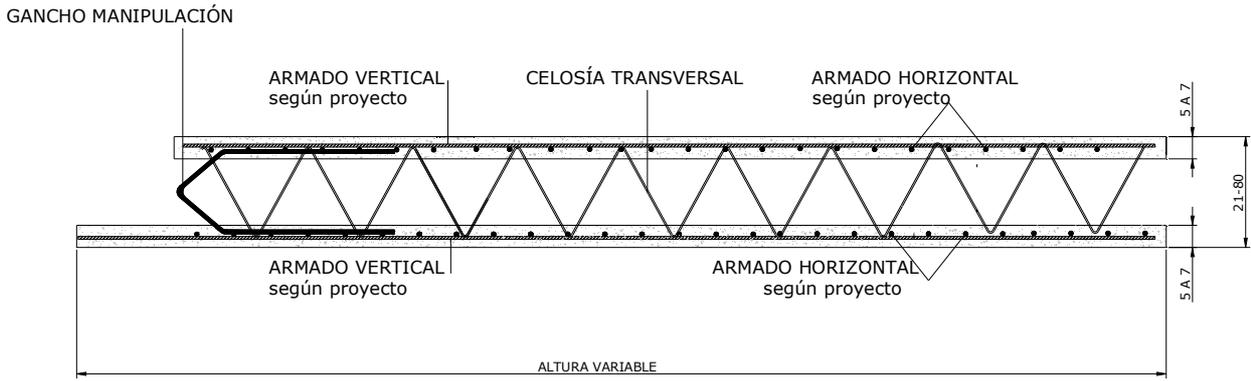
MURO PREFABRICADO – PUESTA EN OBRA
